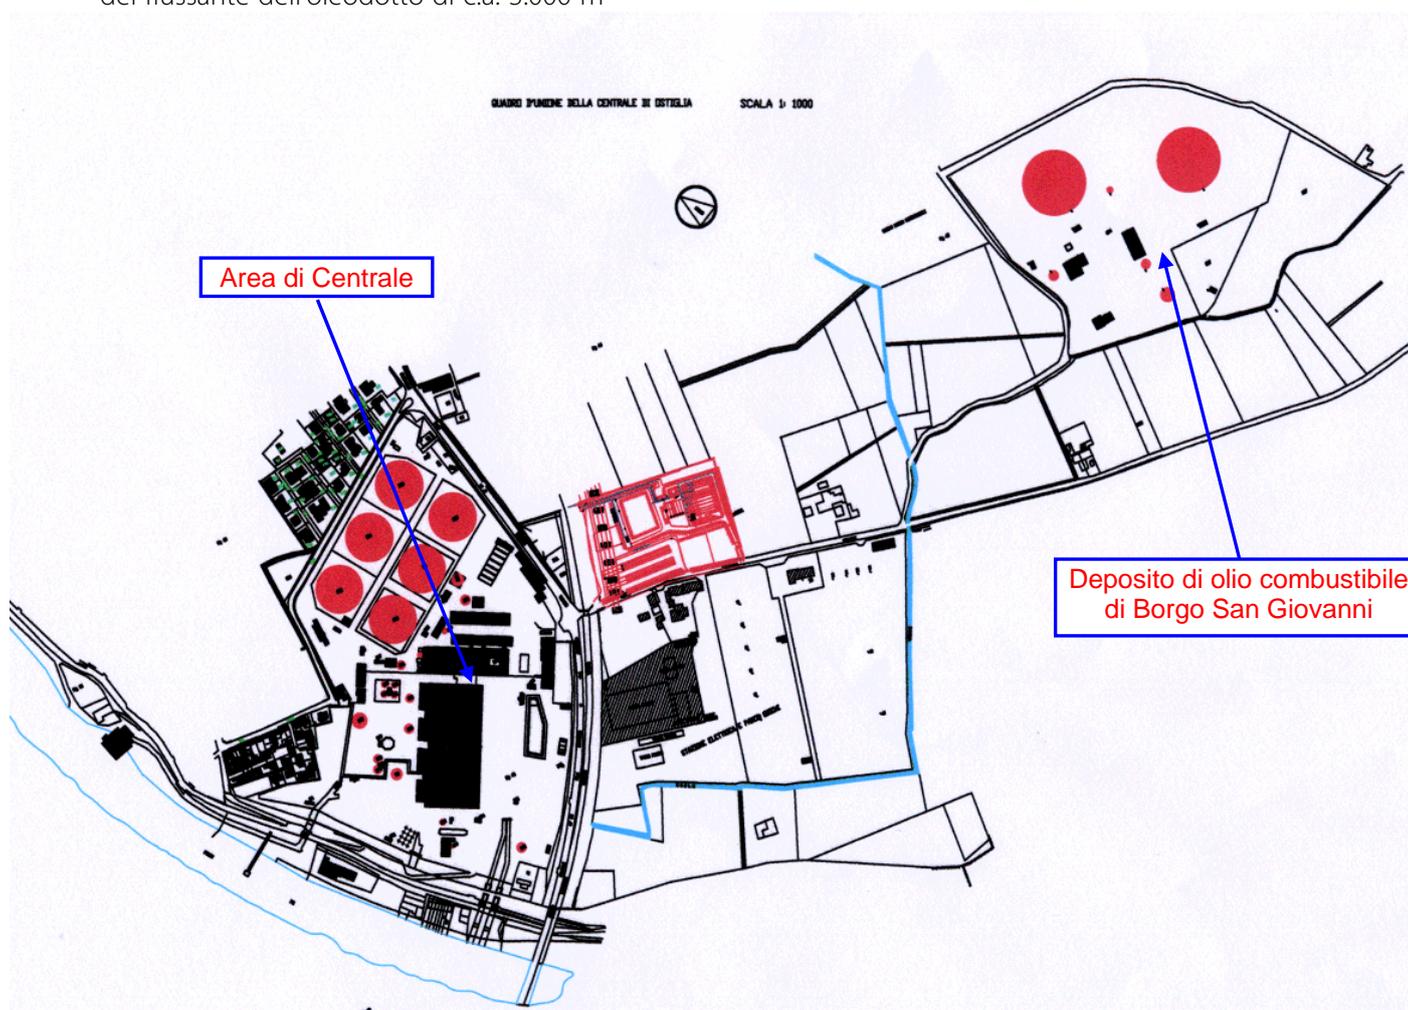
Planimetria generale area di Centrale e deposito Borgo San Giovanni
